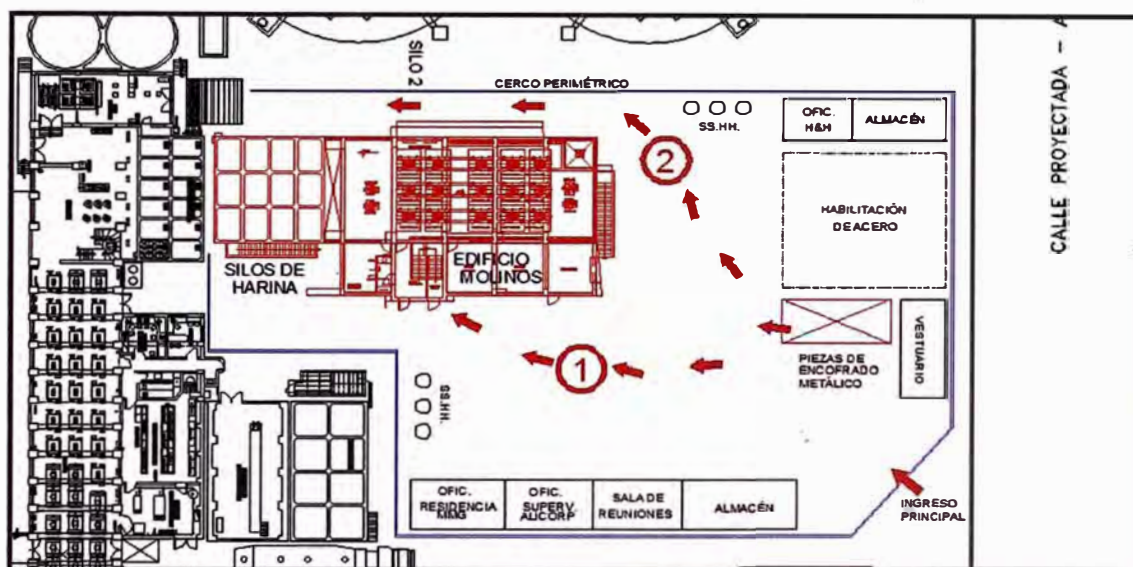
RECORRIDO PARA TRASLADO DE ENCOFRADO
